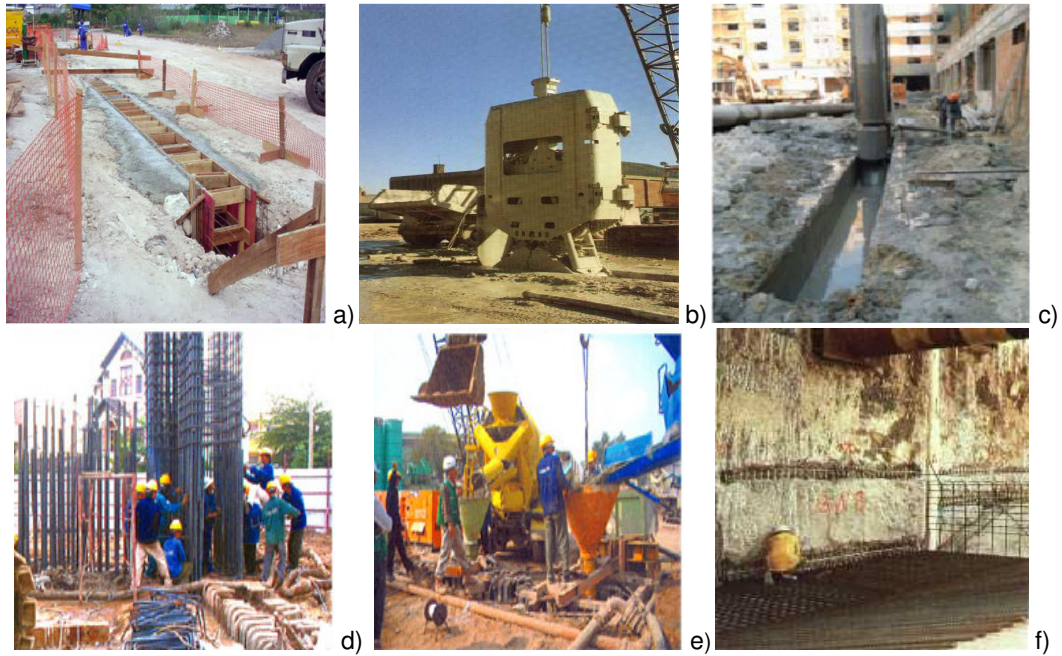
Fotos das principais fases execução de uma parede moldada: a) execução do muro guia; b) escavação c) introdução das lamas bentoníticas; d) colocação da armadura, e) betonagem; f) aspecto final da cortina após a escavação (Matcon, 2004)
